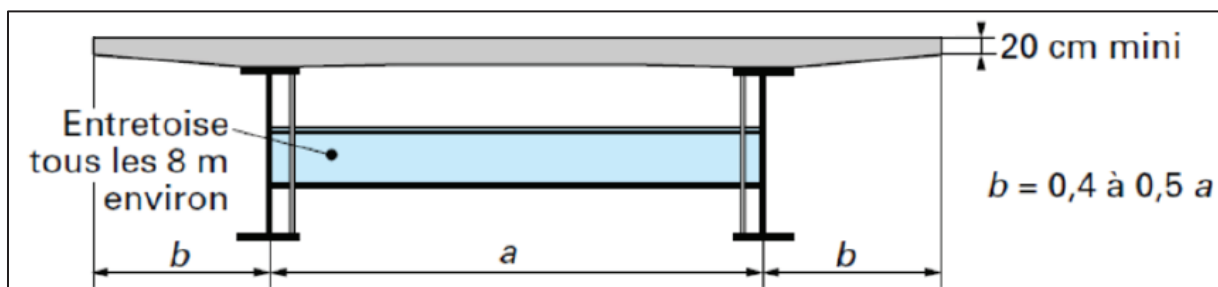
Coupe transversale d'un tablier bipoutre à entretoises.
